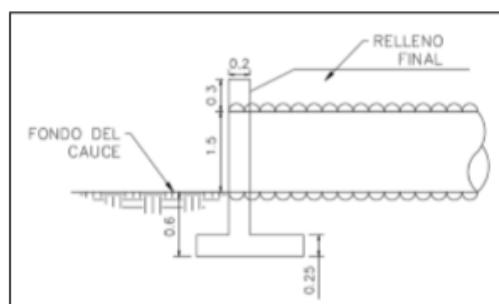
Corte transversal muro boca y tubo PAD Estero 1
